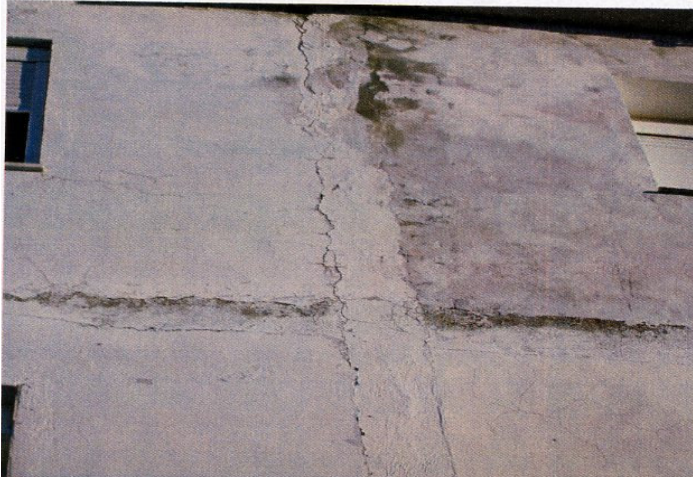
Fisuras por corrosión de las armaduras y falta de zunchos de borde del balcón.
